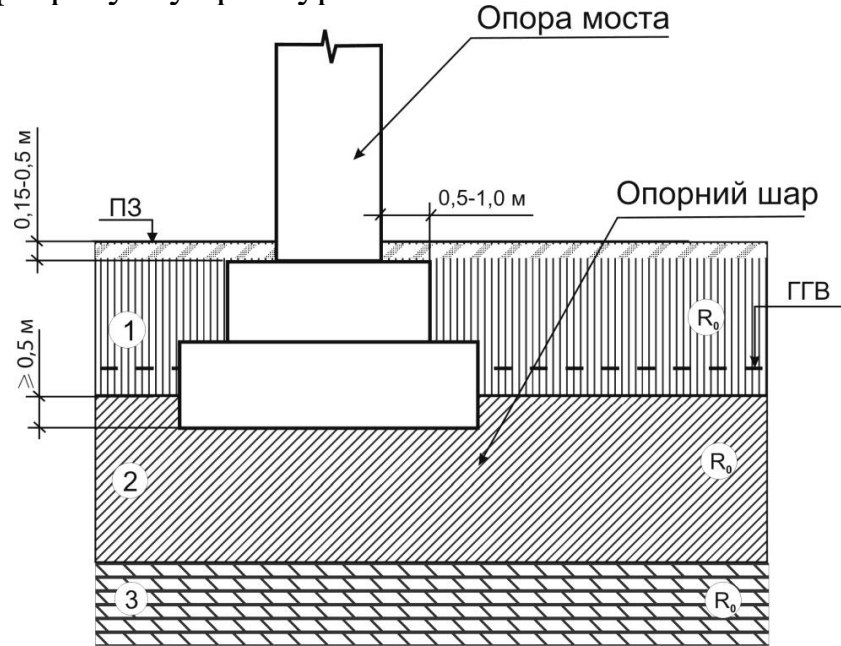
Масивний фундамент мілкого закладання на суходолі
